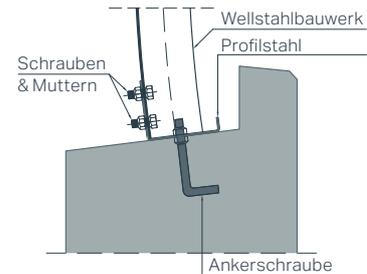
Verbindung der Stahlfertigteilkonstruktion mit Betonstreifenfundamenten
